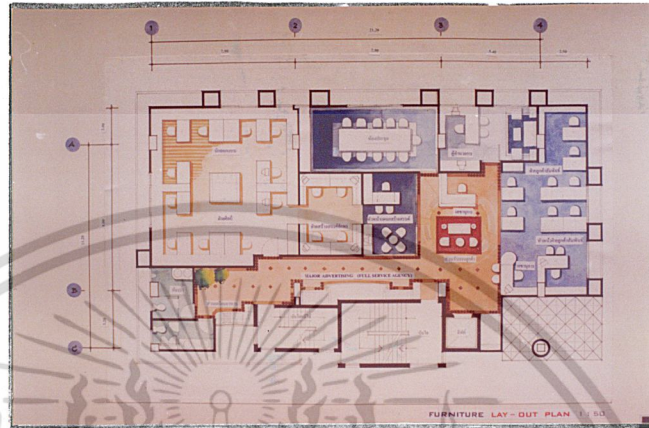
FUNITURE LAY – OUT PLAN 2ND
